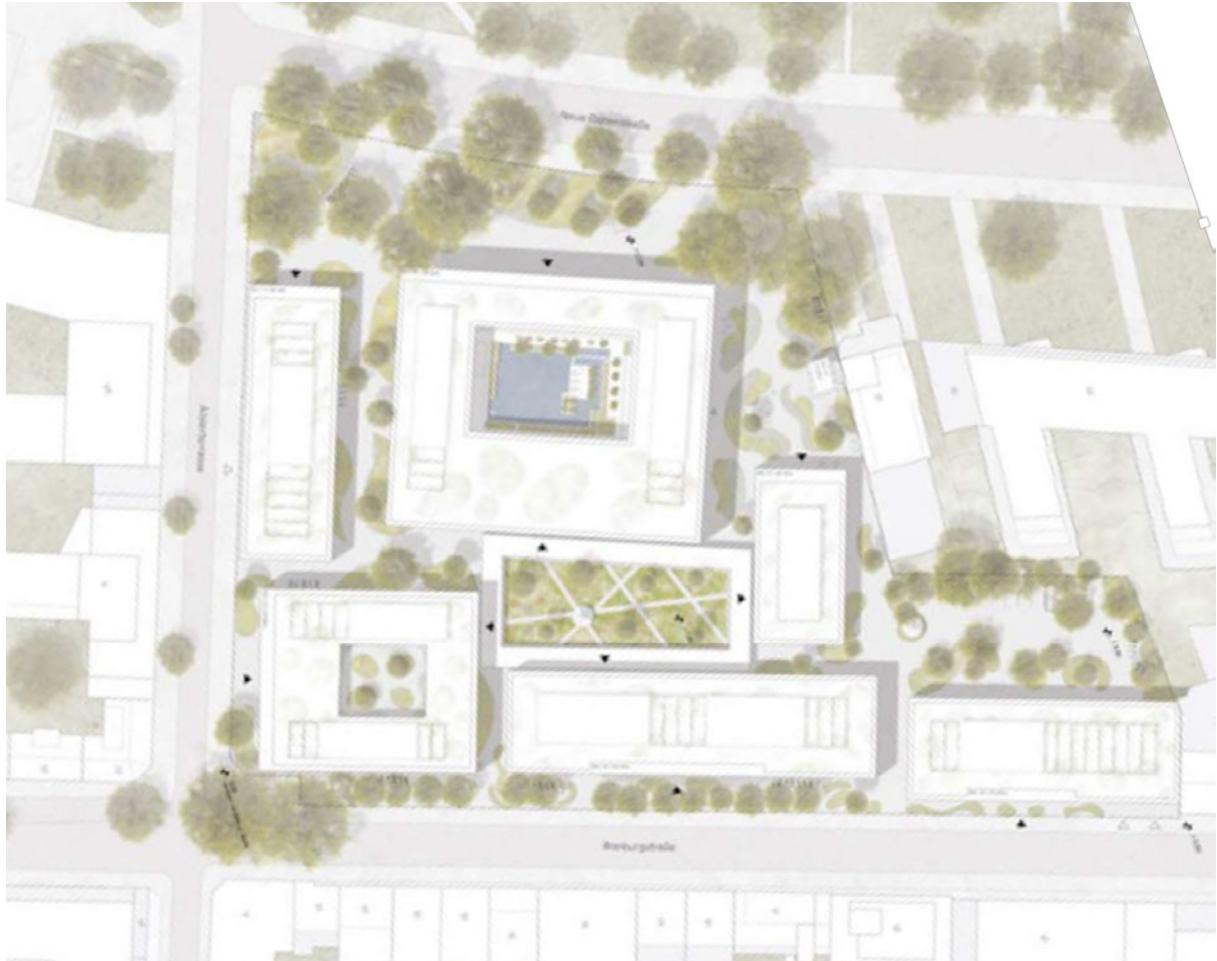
Lageplan der geplanten Bebauung ("David Chipperfield Architects")
